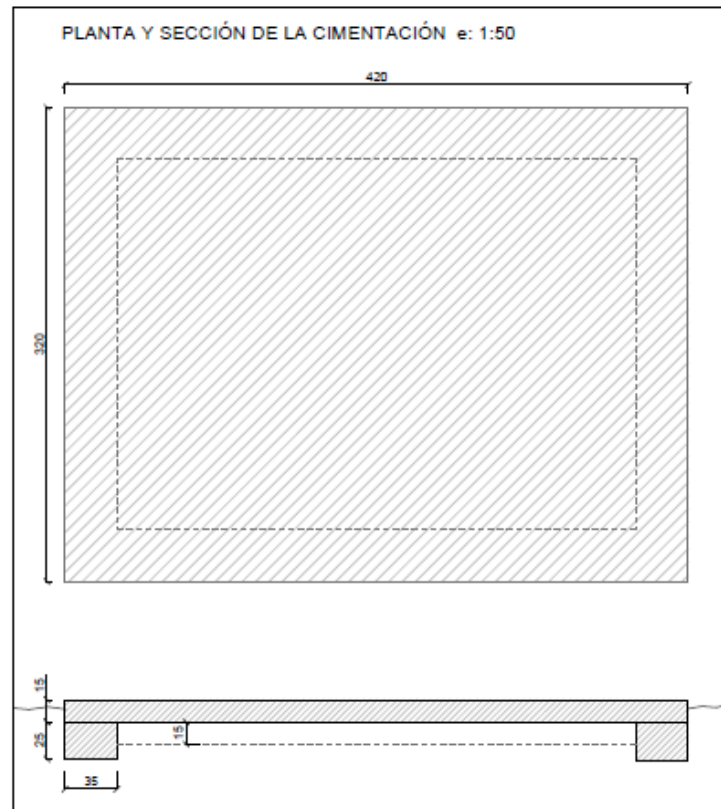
Detalle de la planta y sección de cimentación Fuente: Creación propia
